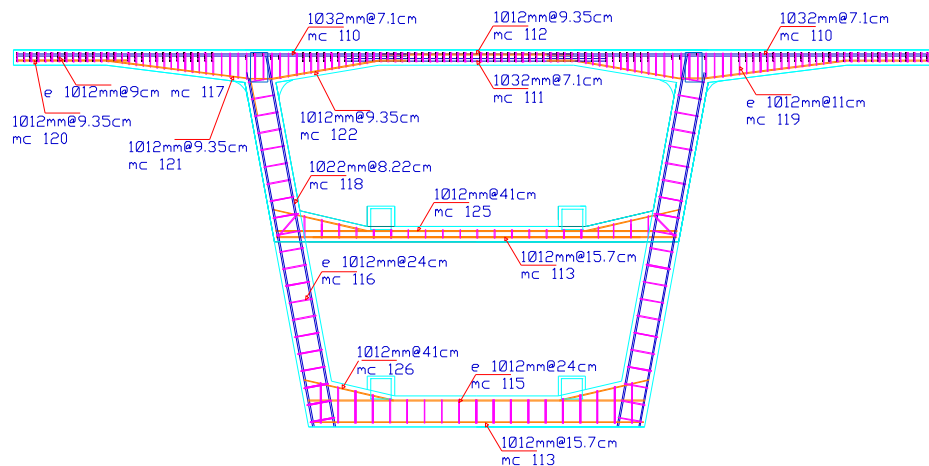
Diseño de hormigón armado de las secciones transversales de 2.8 y 5.5 metros de peralte.
